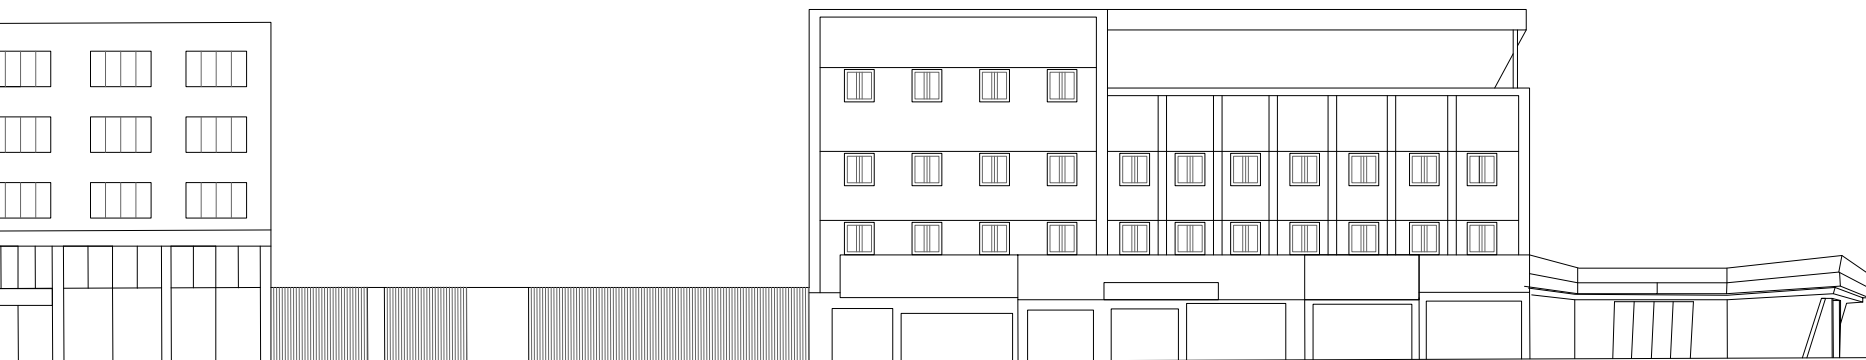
Fachada Oeste. Fonte: produzido pela autora, 2018.
